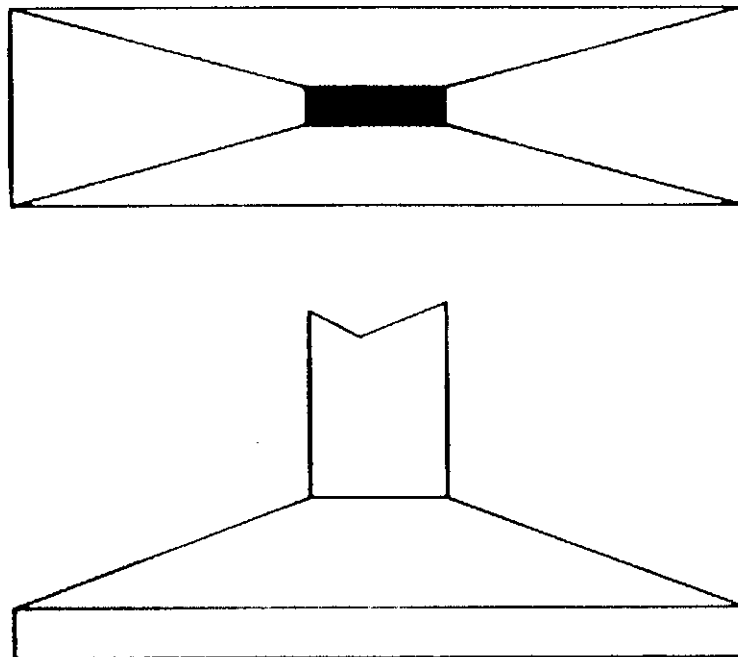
Tipo de fundação da obra: Fundações diretas rasas com sapatas isoladas.
